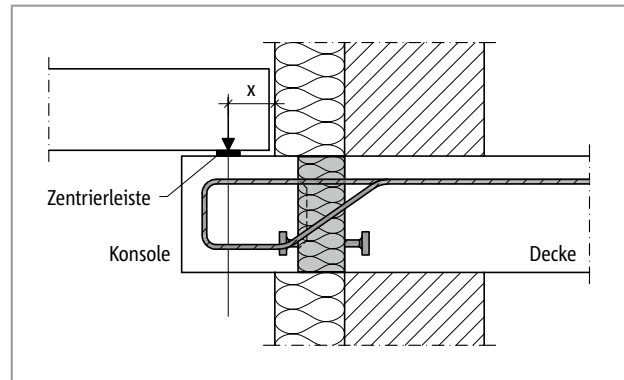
Schöck Isokorb® T Typ O: Anschluss einer Konsole als Deckenaufleger; Zentrierleisten verhindern eine Verschiebung des Lasteinleitungspunktes
